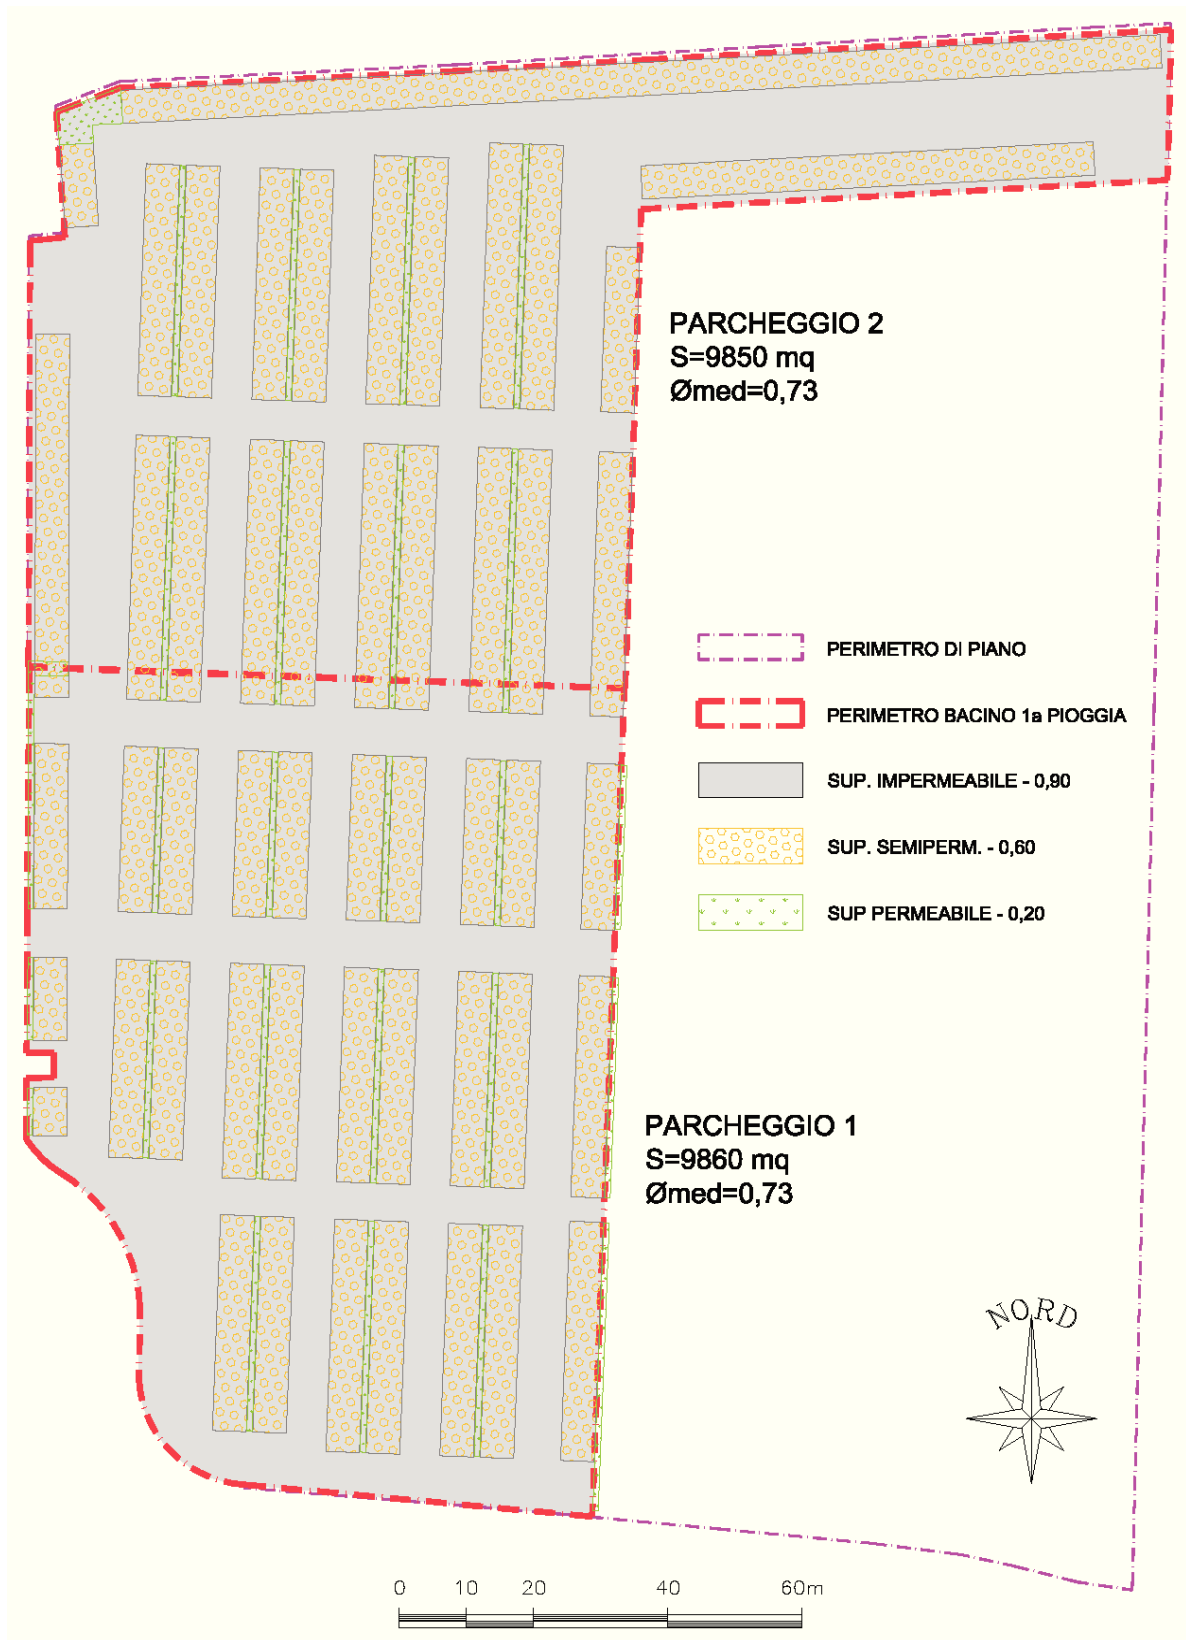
Planimetria dei bacini scolanti delle acque di dilavamento provenienti dai parcheggi.
